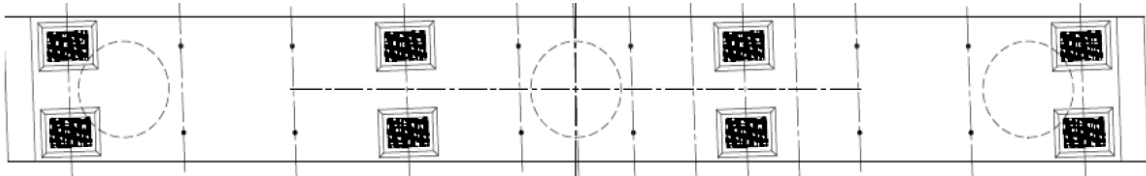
Vista en planta de apoyos elastoméricos y barras sísmicas, Puente Chada [15].
